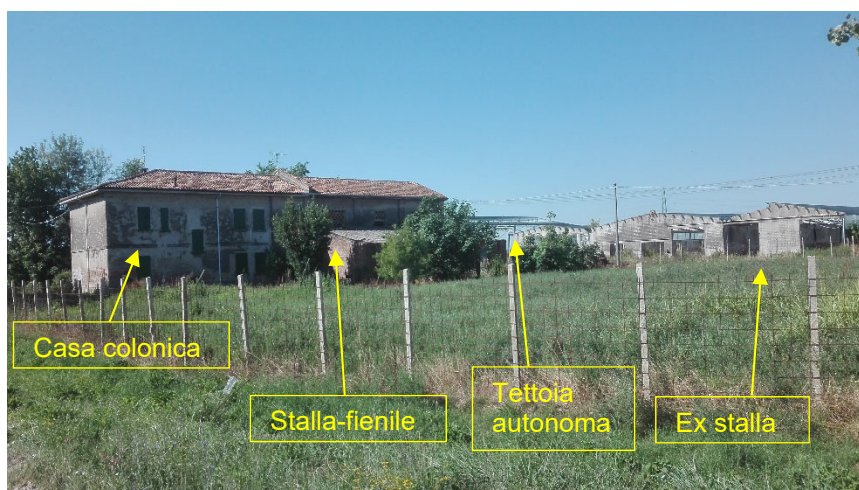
Vista delle tre strutture all'interno dell'area di proprietà
